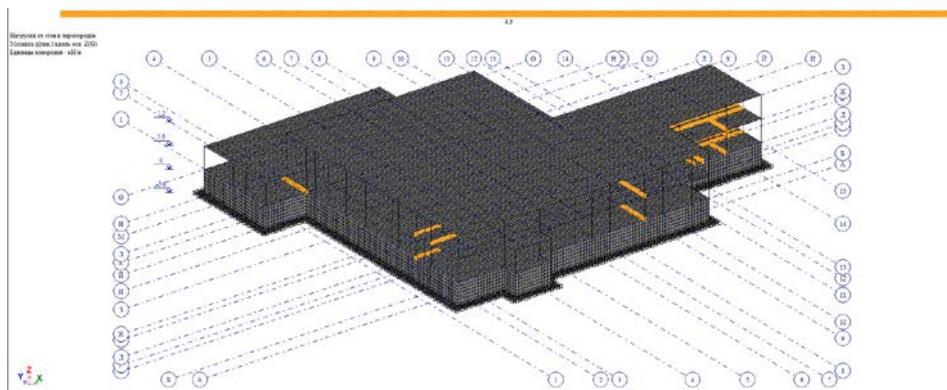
Нагрузки от стен в Lira SAPR
